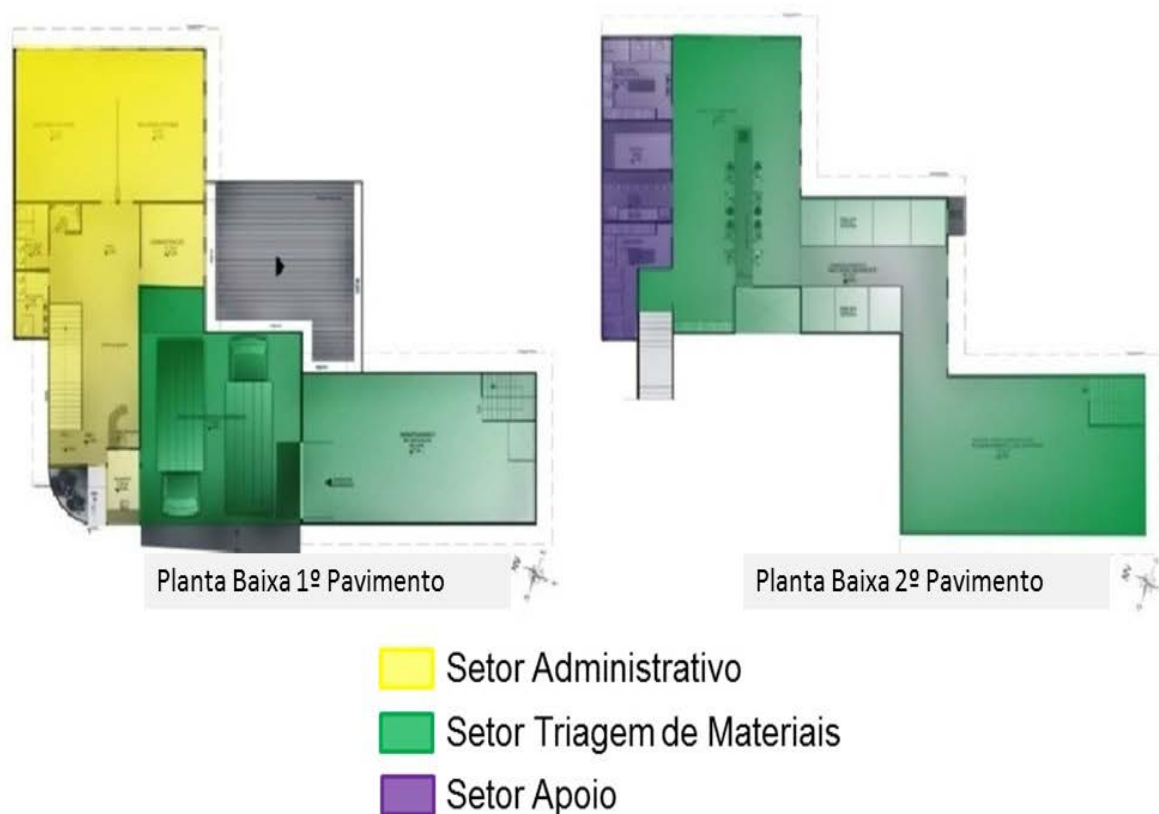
Prédio de Administração e Reciclagem – Planta Baixa
